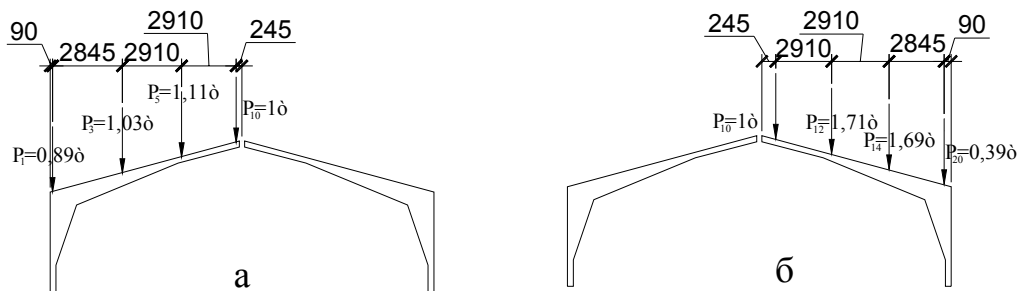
Схема навантаження рами короткотривалим сніговим навантаженням:
